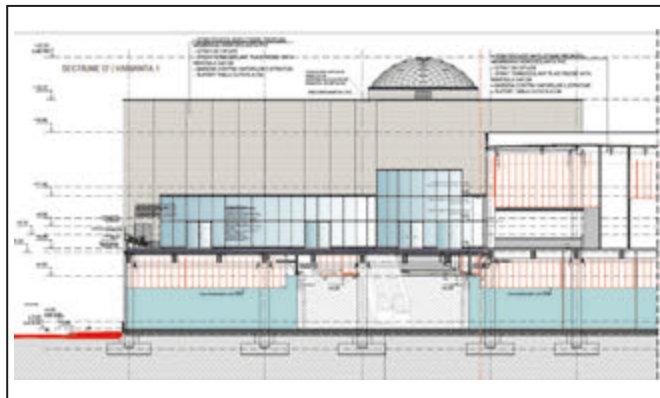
Fațadă laterală (planșe Birou arhitectură HBRO)
